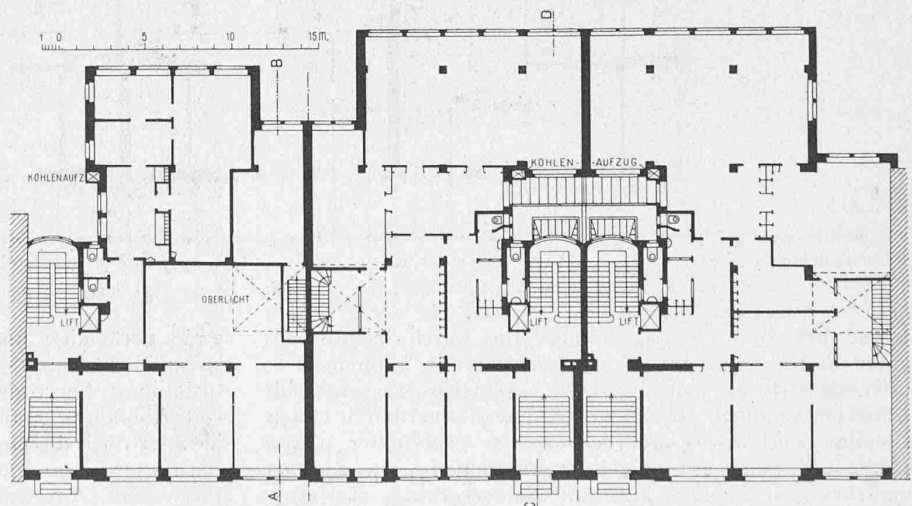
Grundriss vom hochliegenden Erdgeschoss. — Masstab 1:400.
